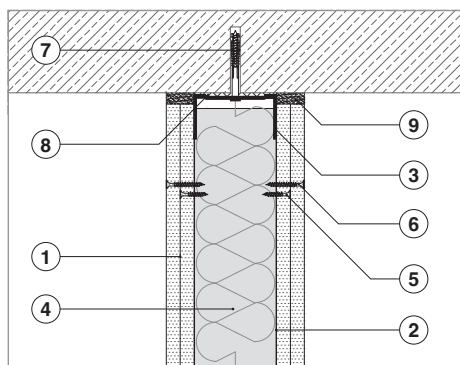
Conexiunea peretelui cu planșeu din beton armat
